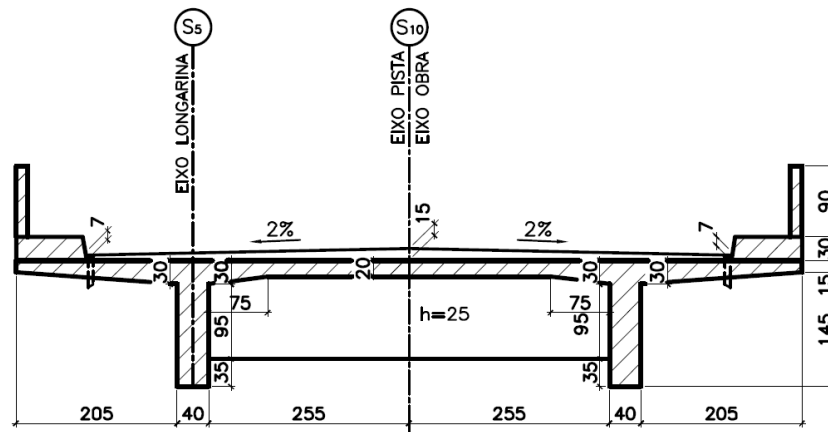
Seções transversais de cálculo das lajes (cotas em cm).
